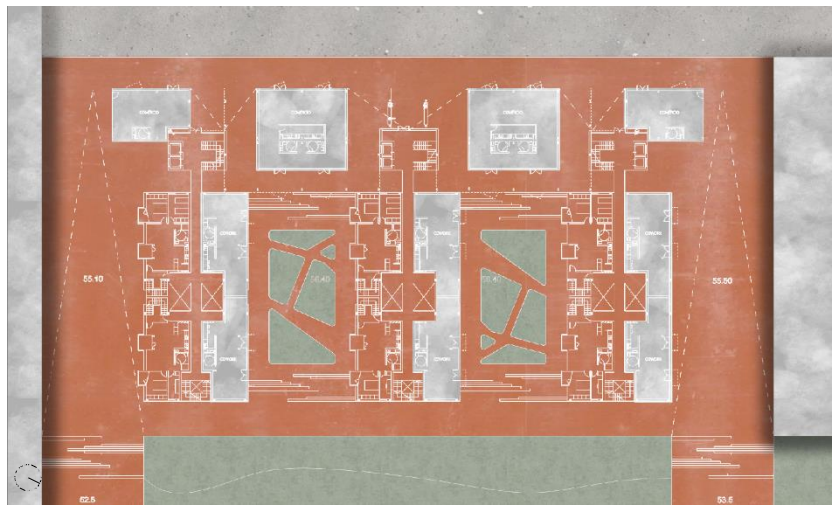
| Planta piso térreo 1:200 comércio e coworking
